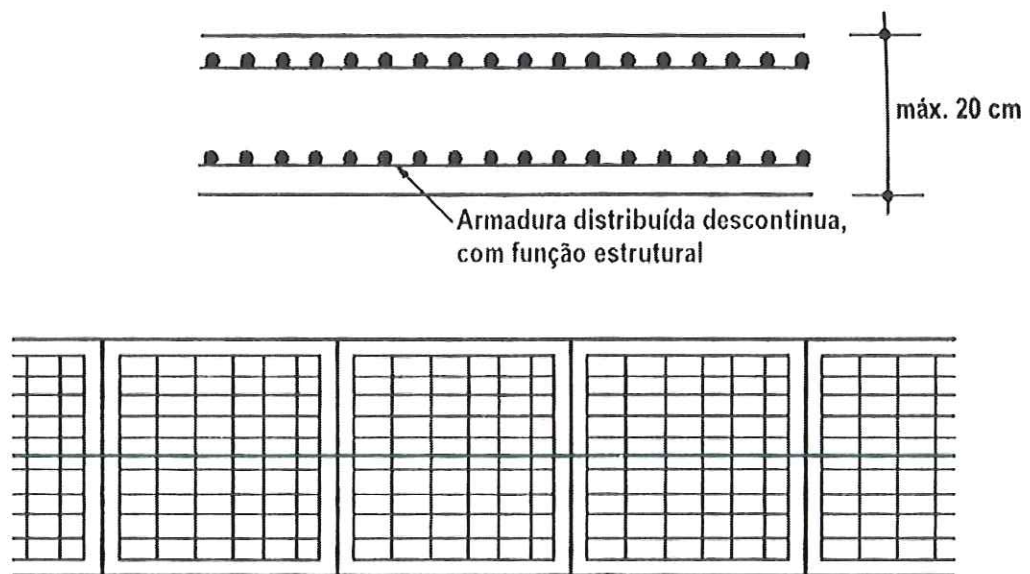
Pavimento de concreto estruturalmente armado (Carvalho e Pitta, 1996).
